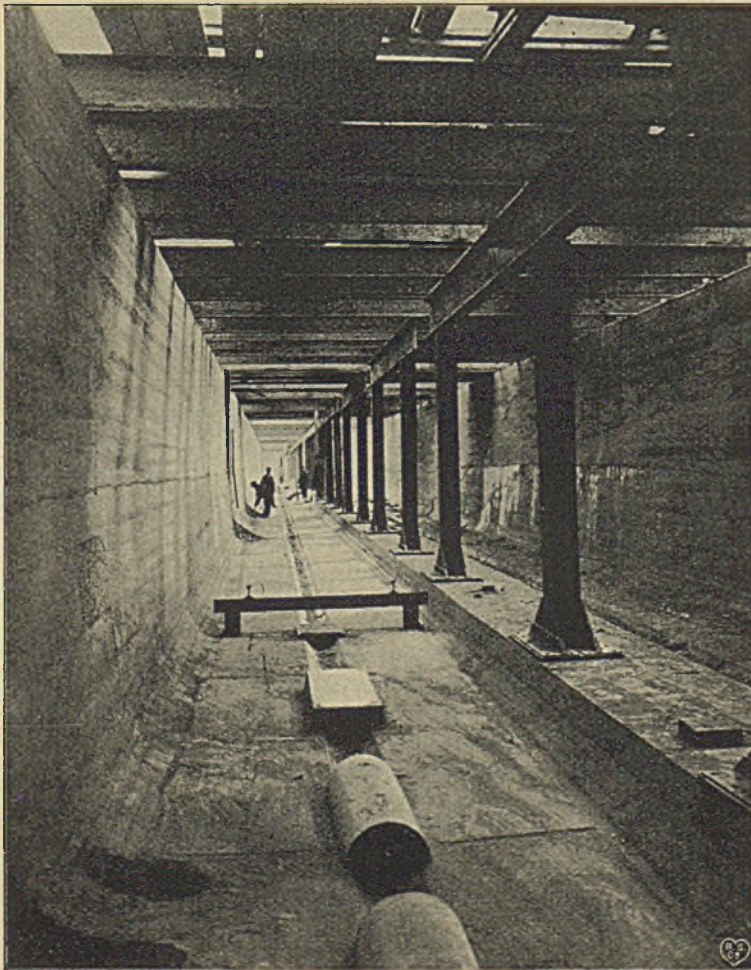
Eisenconstruktion einer Tunnelstrecke.
